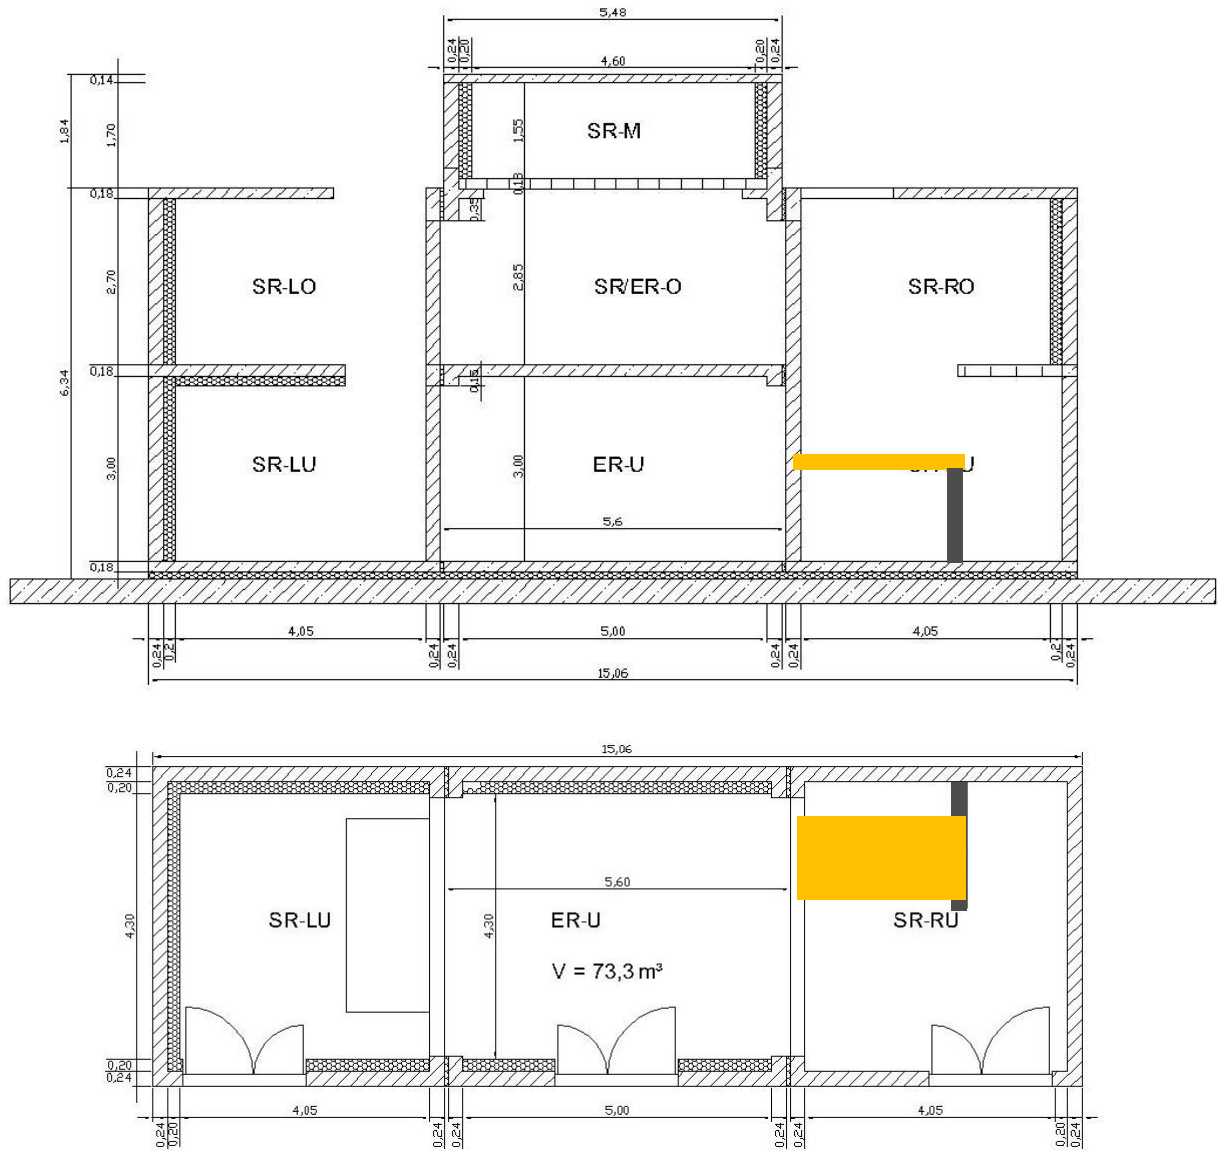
Grundriss und Schnitt des Treppenprüfstandes mit Skizzierung der Prüfaufbauten (nicht maßstäblich) mit Referenztreppenpodest (gelb) und Hilfswand (grau). Der Raum mit der Bezeichnung ER-U ist der Empfangsraum für die horizontale Trittschallübertragung
